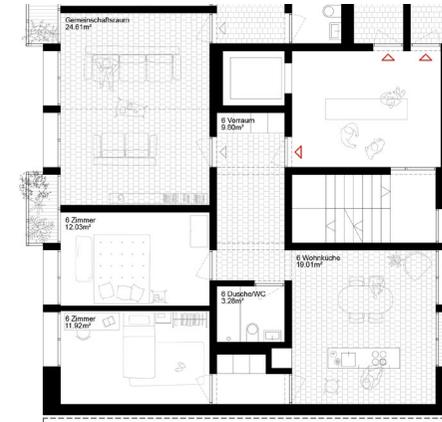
Grundriss mit Gemeinschaftsräumen als Ausbaureserve | Lacol (Barcelona)
